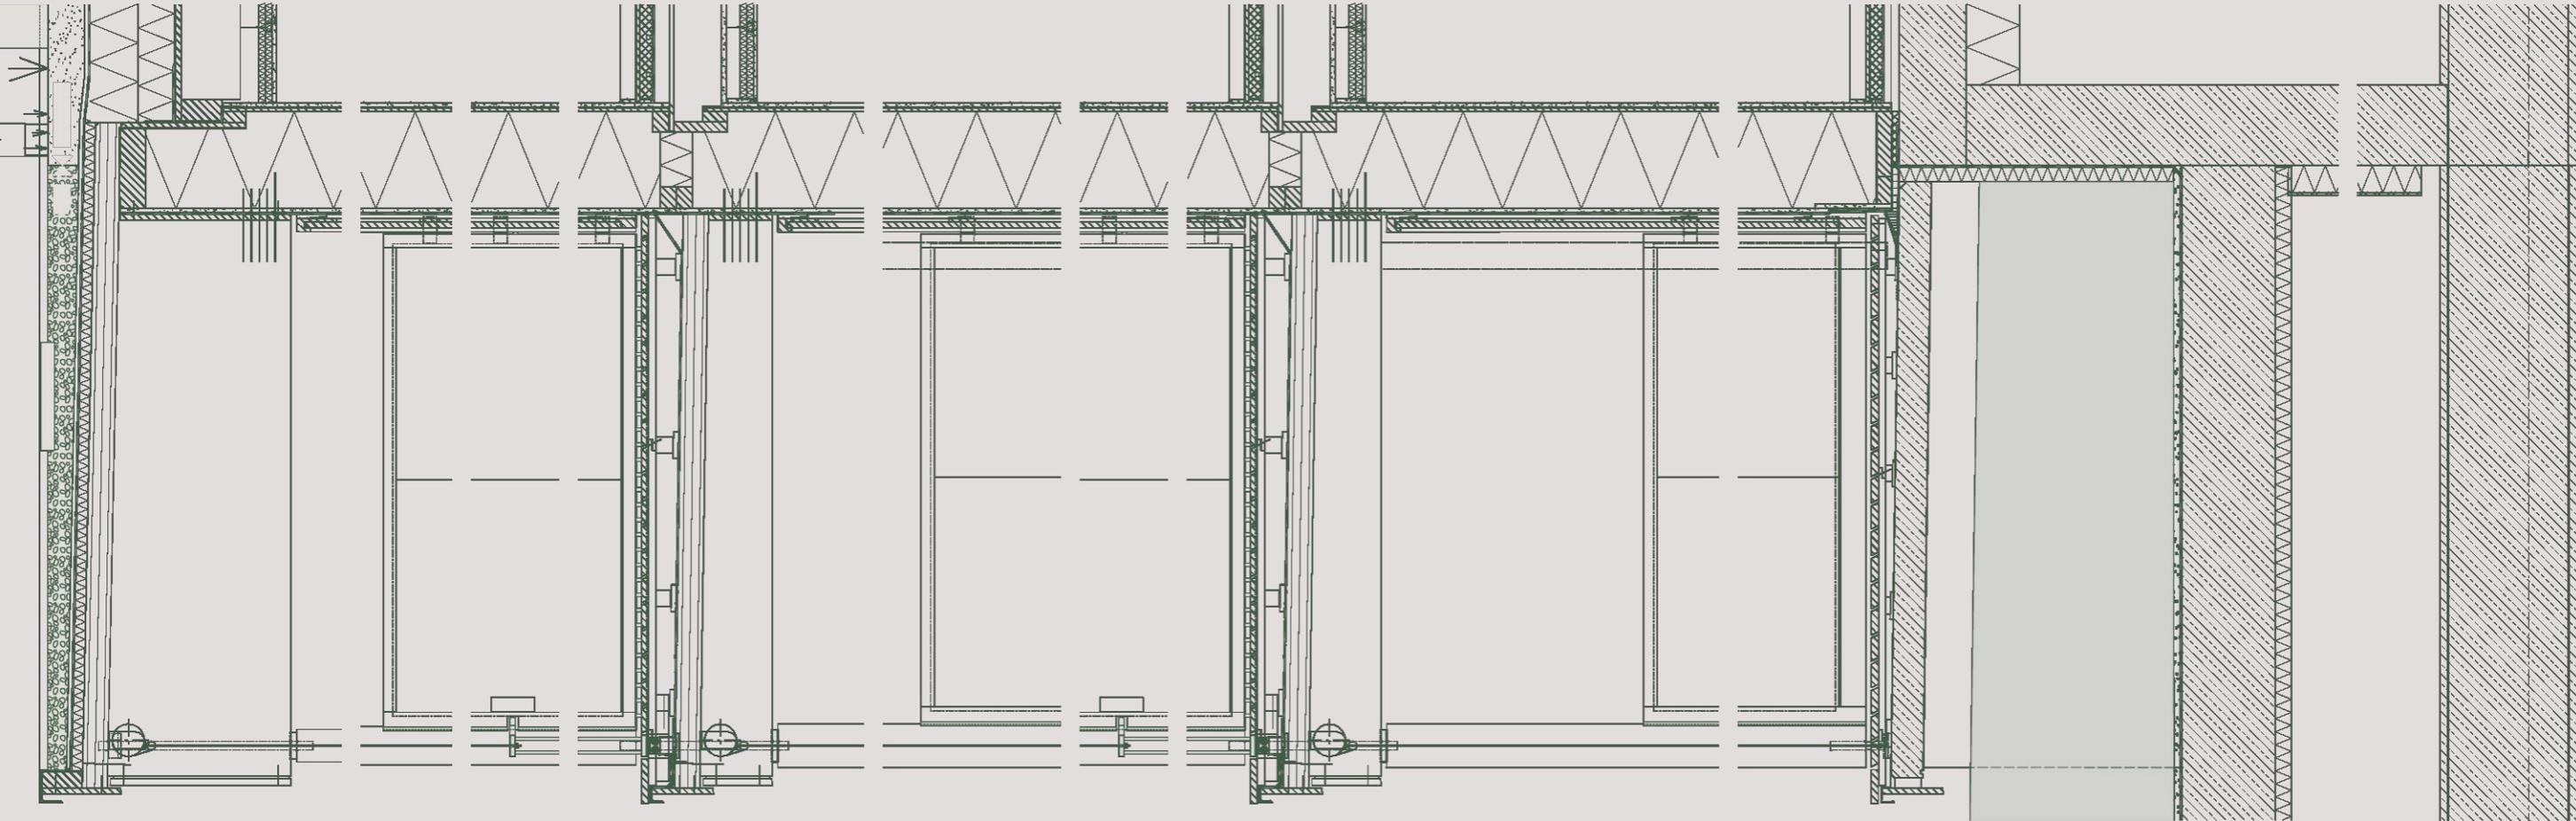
Vertikalschnitt durch Dämmung M 1:25
